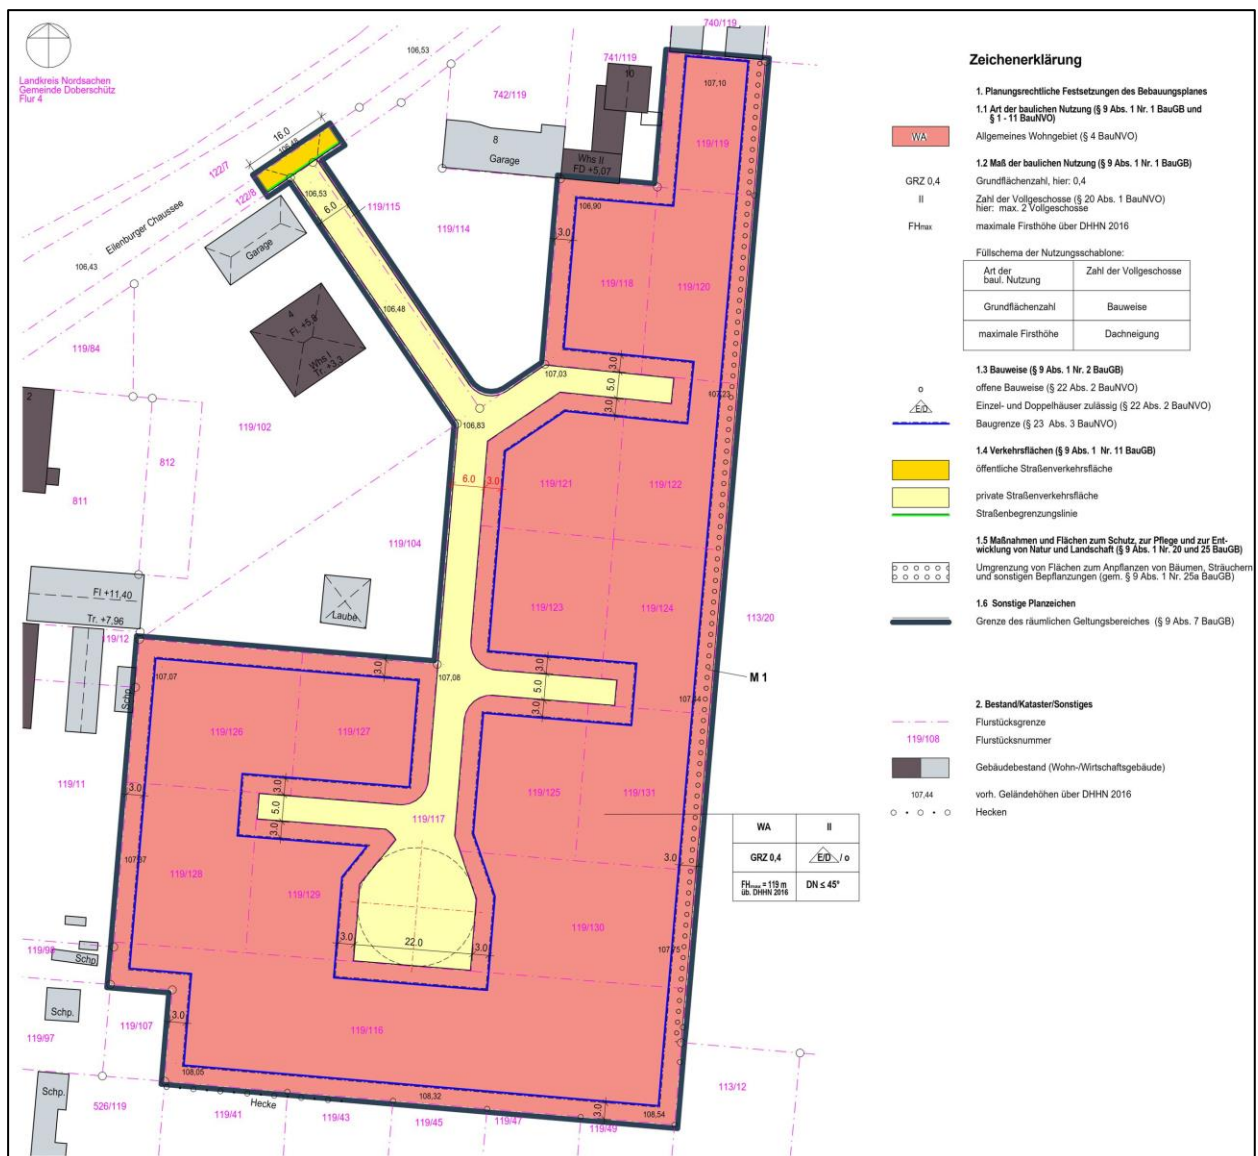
Vorentwurf BPlan „Eilenburger Chaussee“ Doberschütz; Stand: 10.04.2025, (ohne Maßstab)
